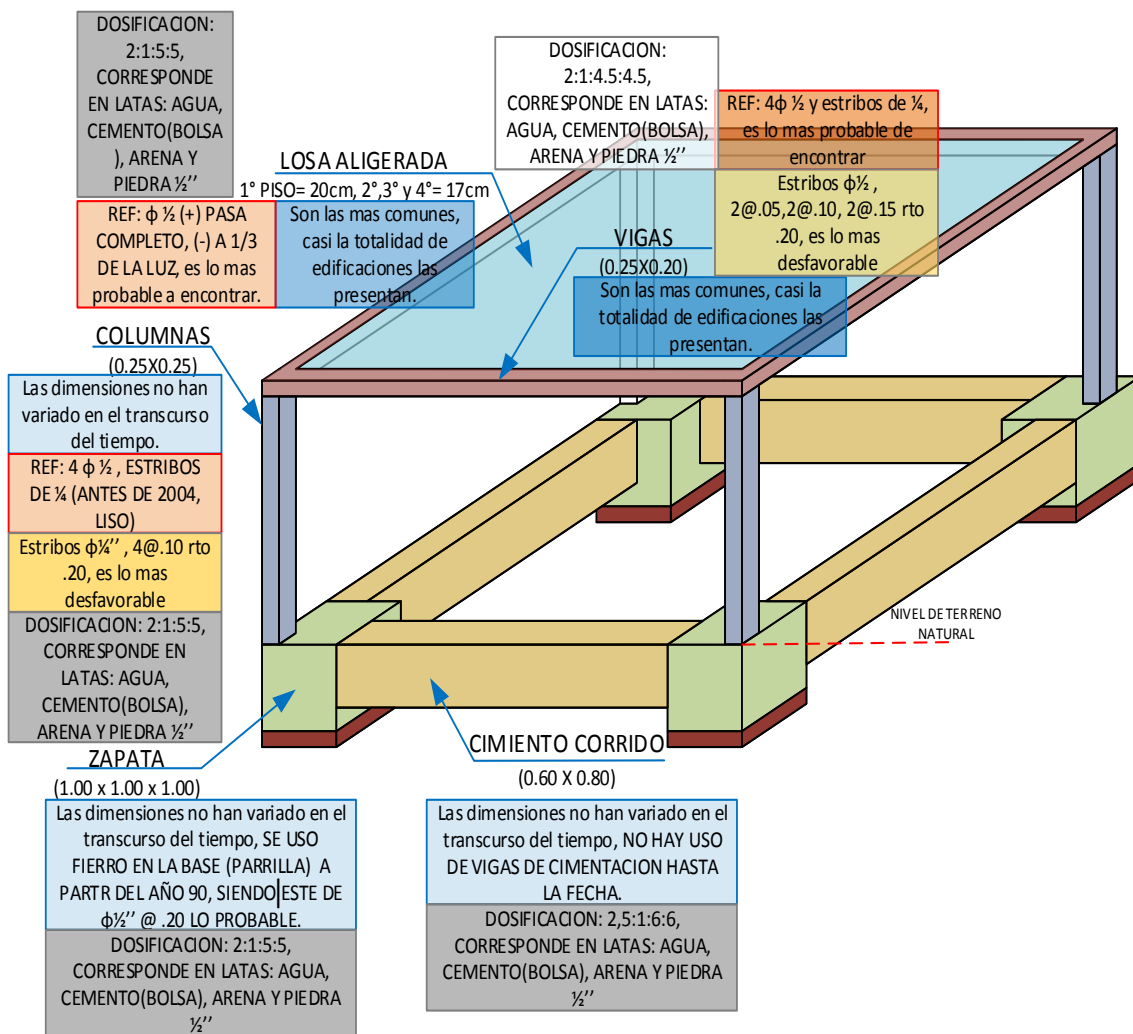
Realidad de las construcciones en el distrito de la esperanza-parte baja para determinar las fallas constructivas
